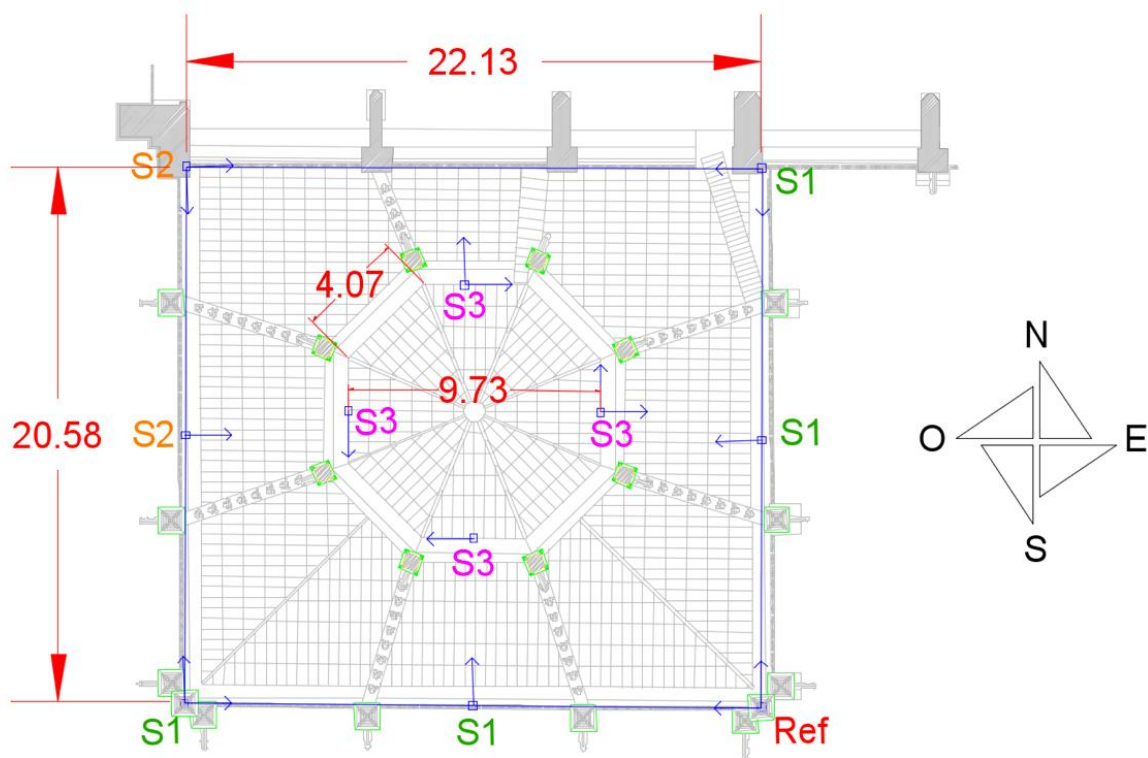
Planta da Capela do Fundador com o esquema de Setups considerados
